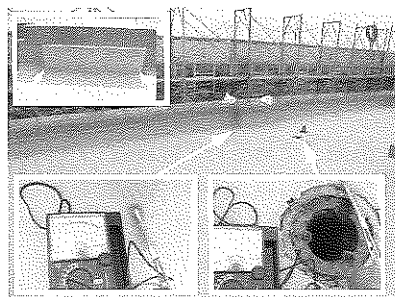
ドレン回りおよび立上り入隅と下階漏水部のひび割れで通電を確認
